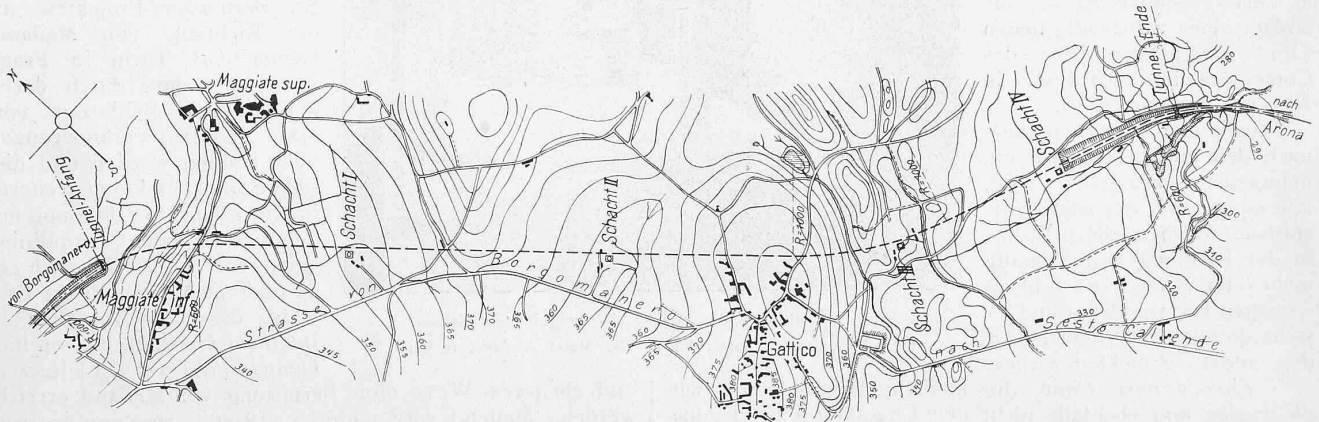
Lageplan des Gattico-Tunnels. — Masstab 1 : 20 000.
